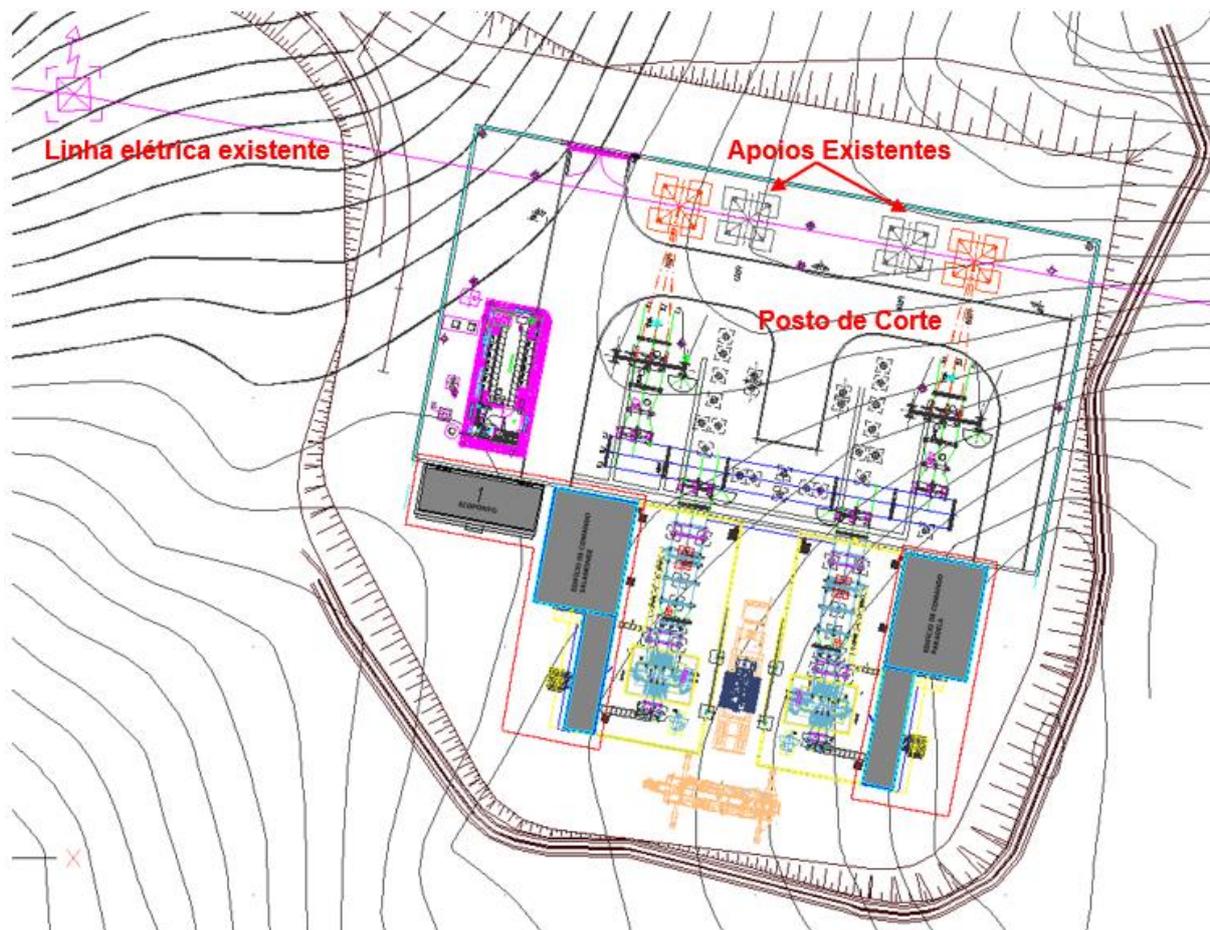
Ligação das Subestações dos Projetos Híbridos de Salamonde e Paradela ao Posto de Corte e à linha elétrica existente.
